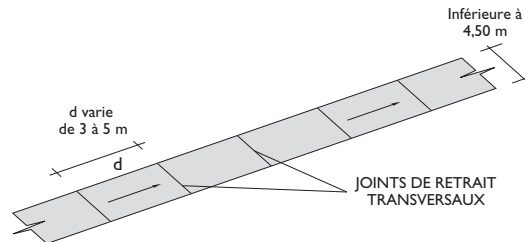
Schéma de jointoiement pour une voirie à une voie de circulation
